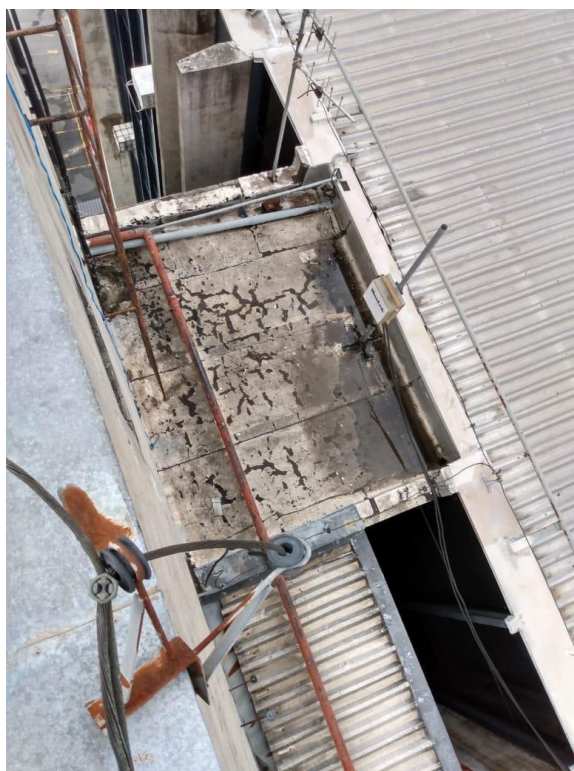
Vista Cobertura (02/03/2021) manta sem proteção mecânica
